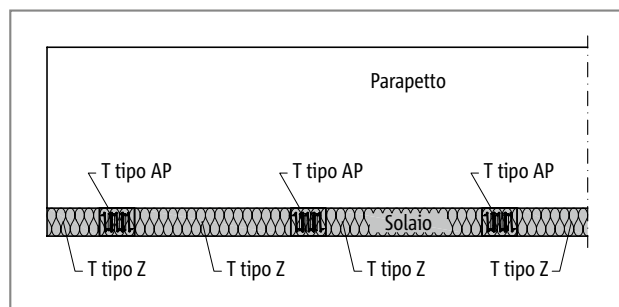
Schöck Isokorb® T tipo AP disposizione orizzontale: vista parapetto anteposto
